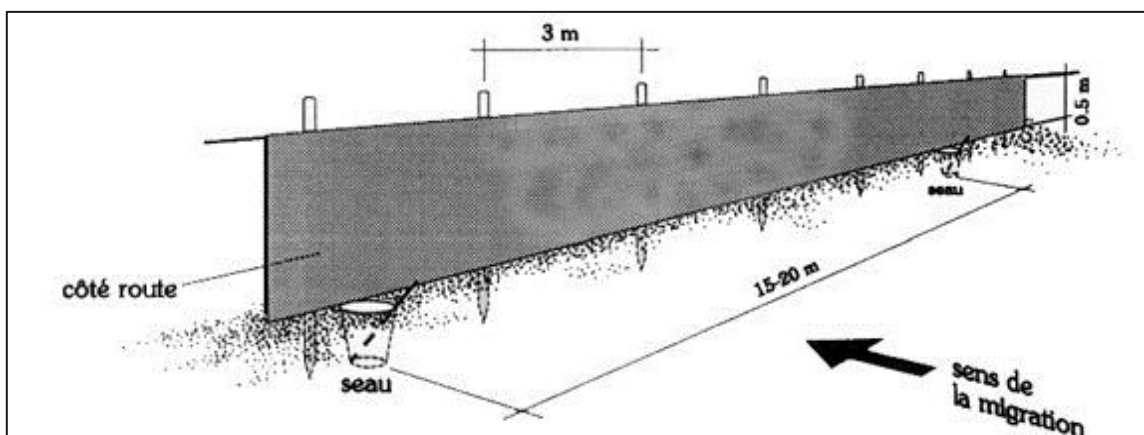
Schéma type d'une barrière de protection en faveur des amphibiens installée en bord de route d'après Percsy
